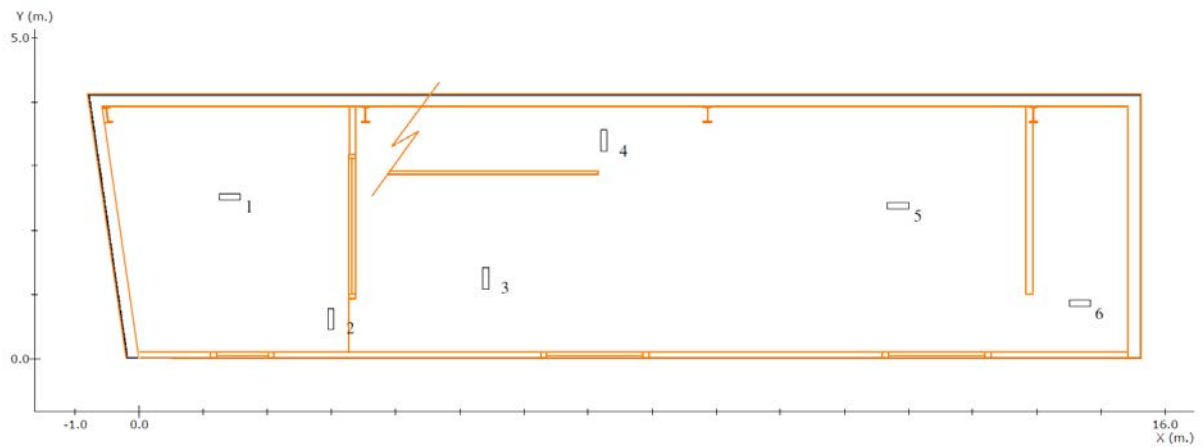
Situación de las luminarias de emergencia (Planta primera).
